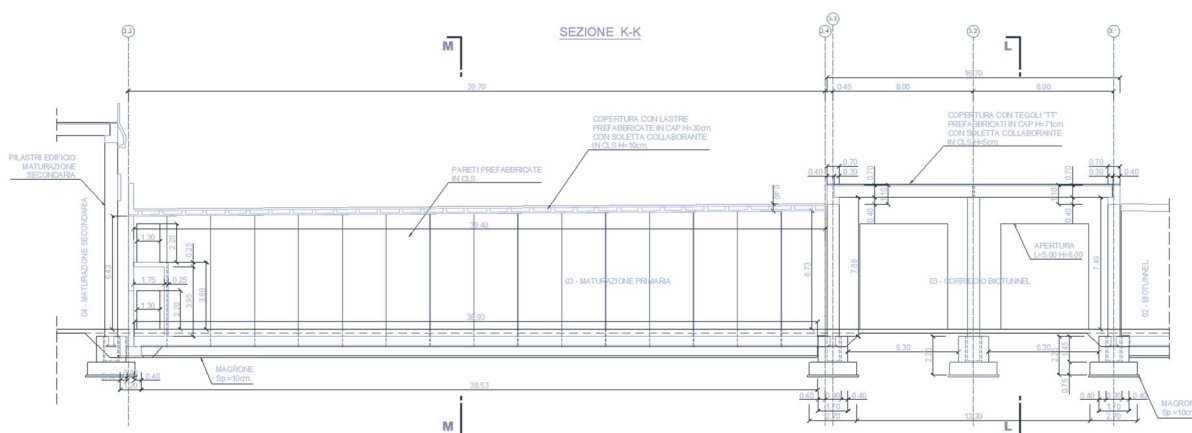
SEZIONE LONGITUDINALE MATURAZIONE PRIMARIA
